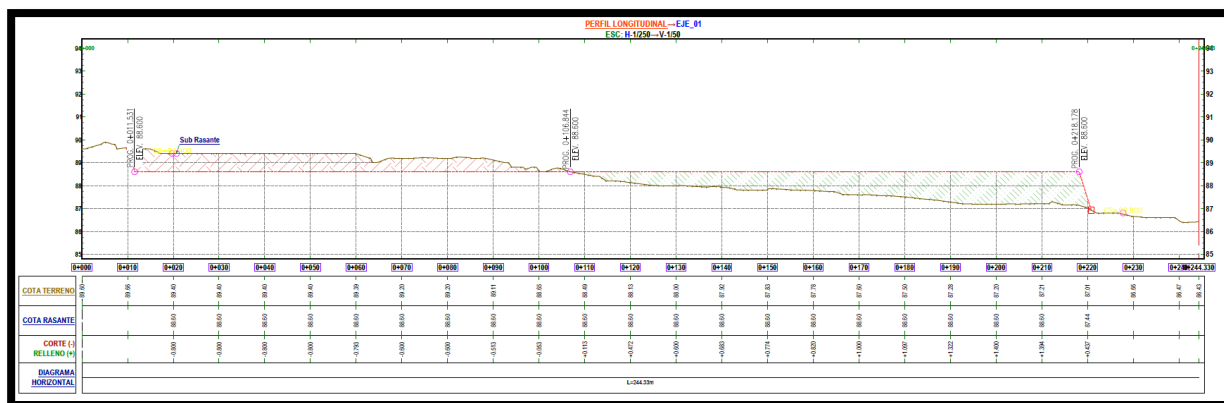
Perfil Longitudinal incl. Elevación y Rasante del Terreno del área a intervenir
